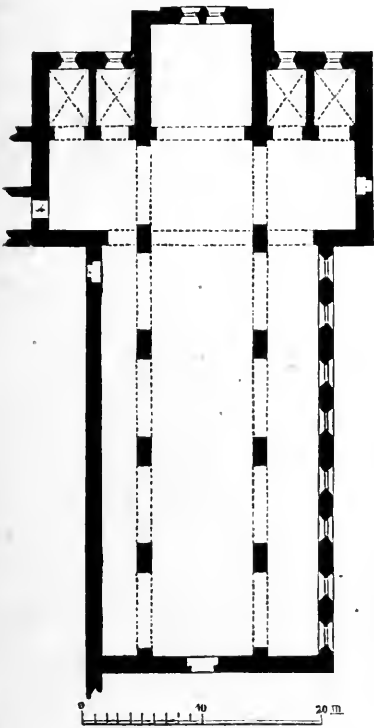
Ursprünglicher Grundriss der Kirche zu Pforta.
